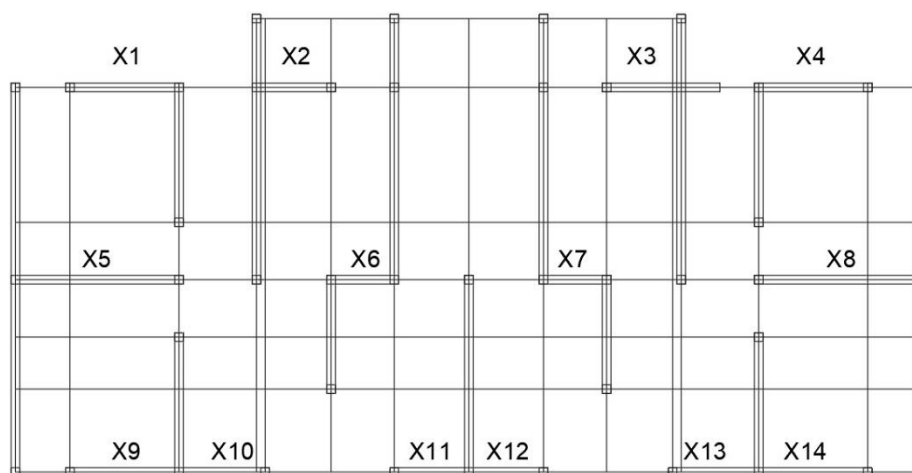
Identificación de muros de mampostería del modelo en la dirección X.
